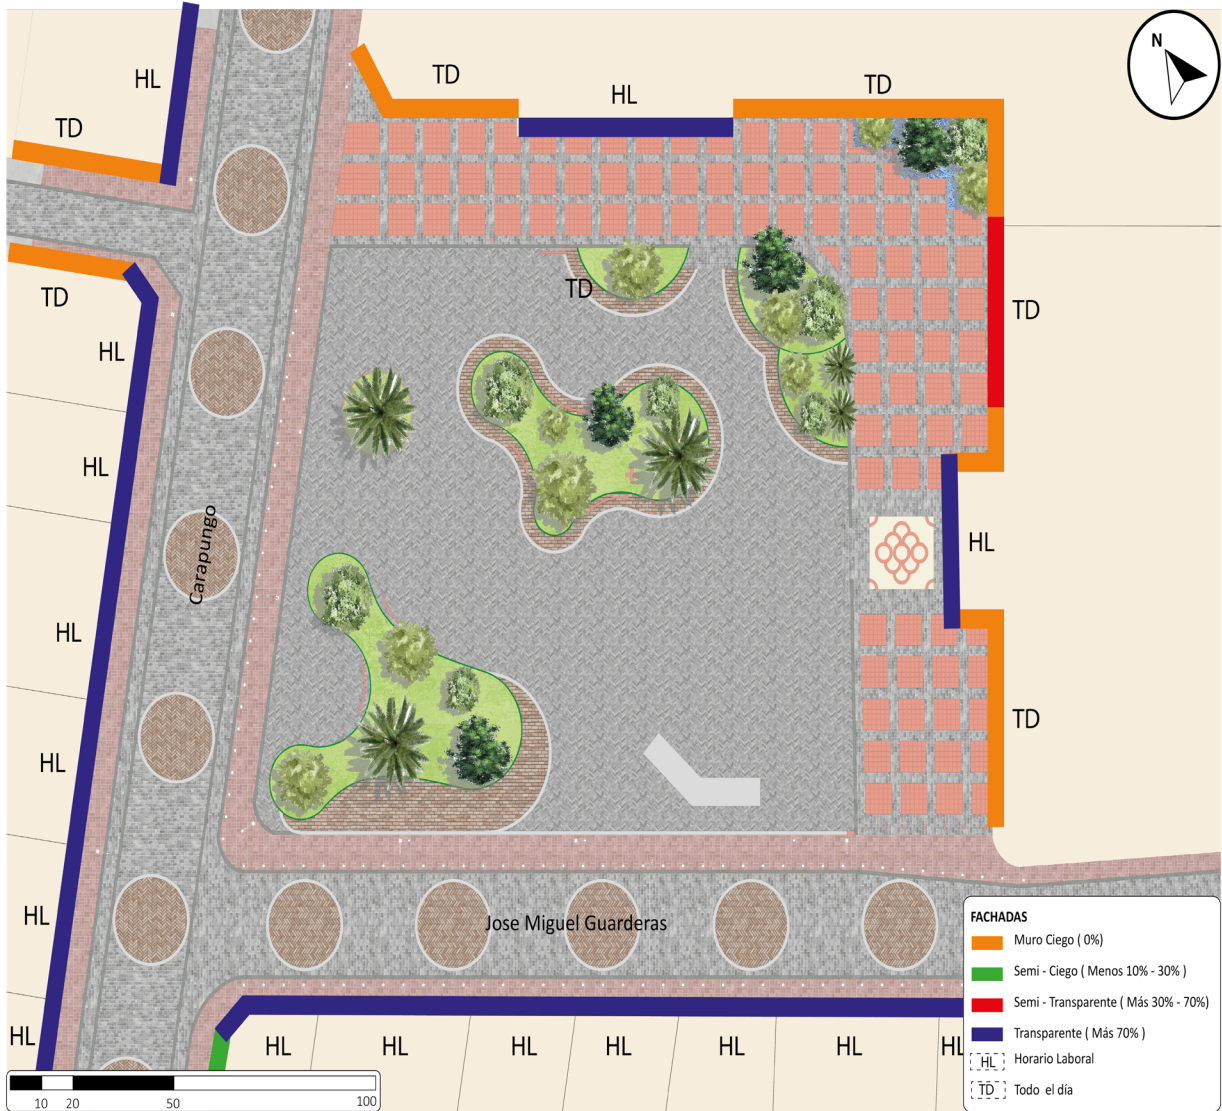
Cerramientos en Planta Baja, Plaza Central de Calderón
